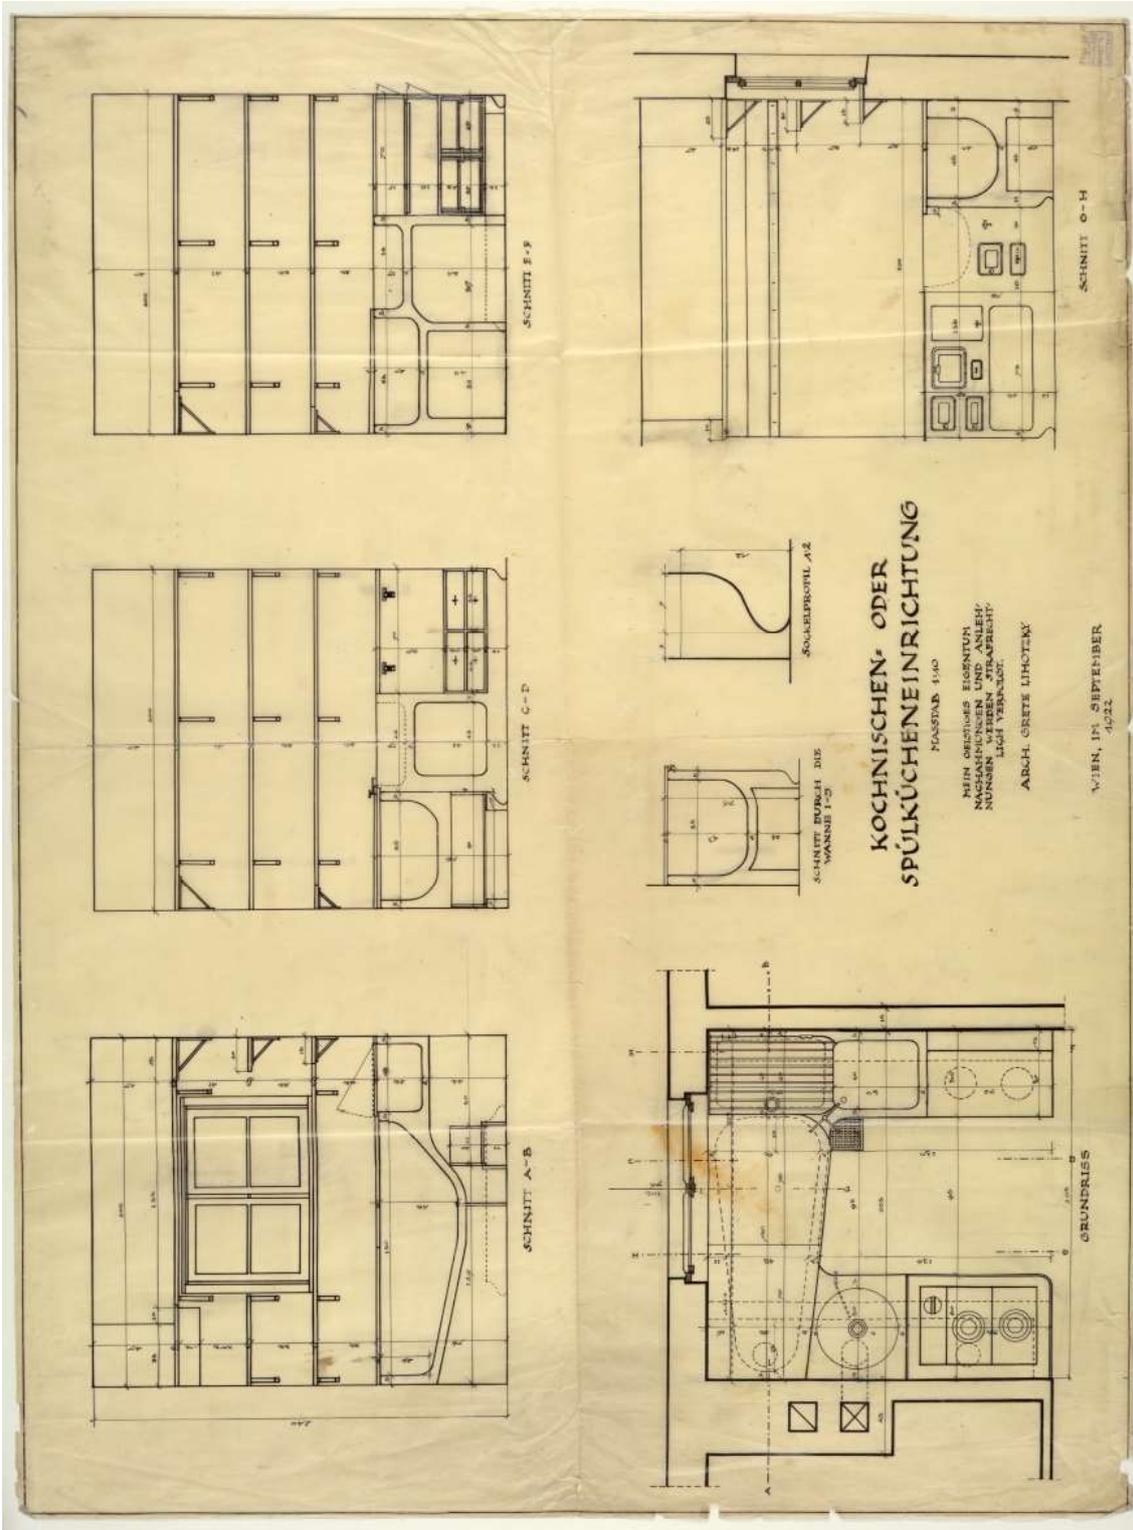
Abb.XXII:Spülkücheneinrichtung. Grundriss, Ansicht und Schnitt.
